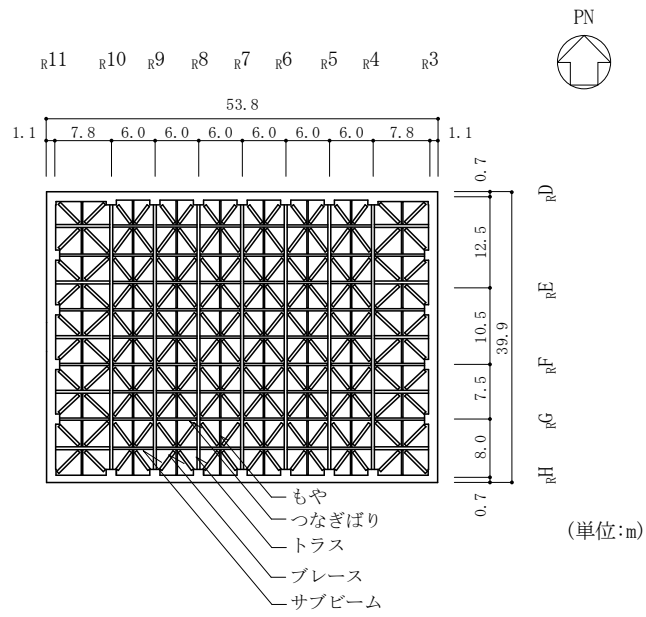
(9) 原子炉建物の概略平面図 (EL 63.5m)
